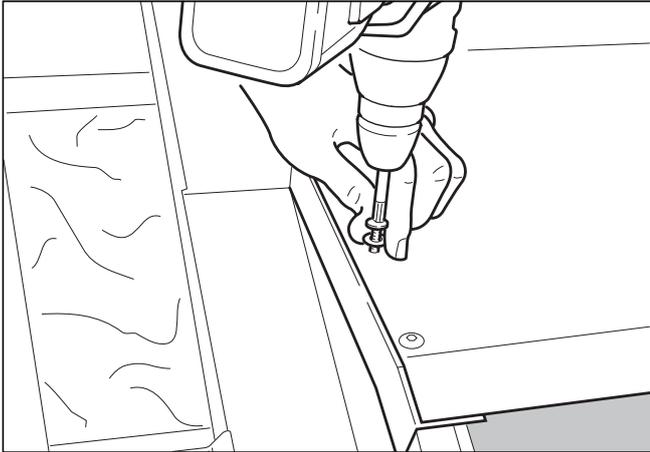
Соединить углы с верхним запорным щитком с краю при помощи соответственно 3 саморезов с полупотайной головкой (самонарезающие винты) с подкладными шайбами.
